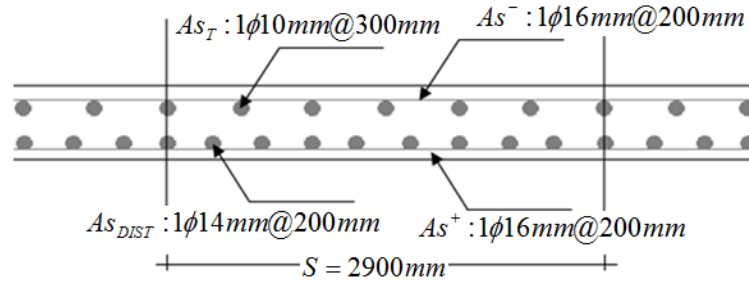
Armado de los vanos interiores del tablero (corte transversal)
